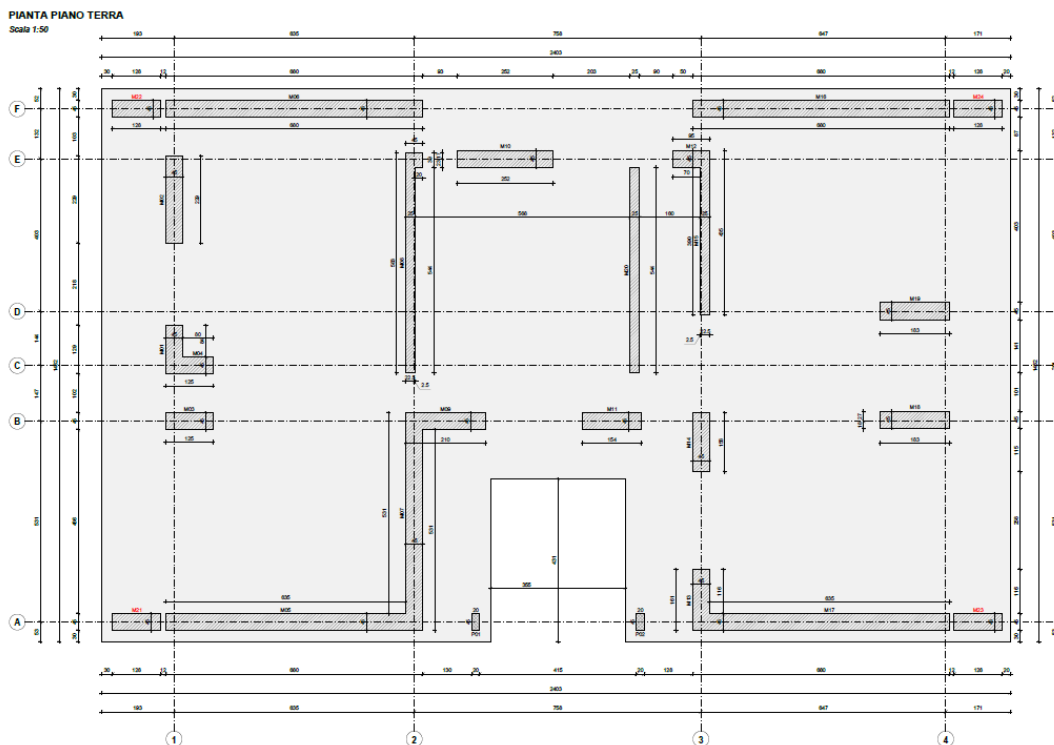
Progetto strutturale esecutivo - Pianta piano terra
